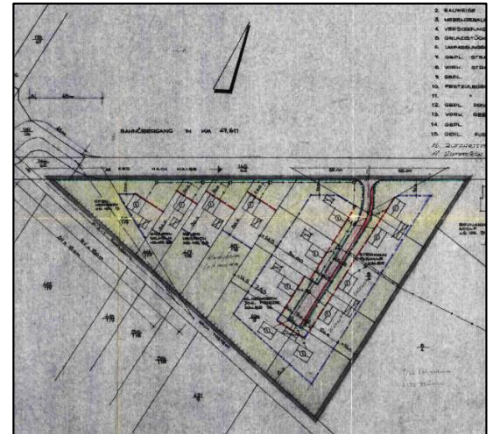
B-Plan Nr. 1; Tiste (Ausschnitt)
